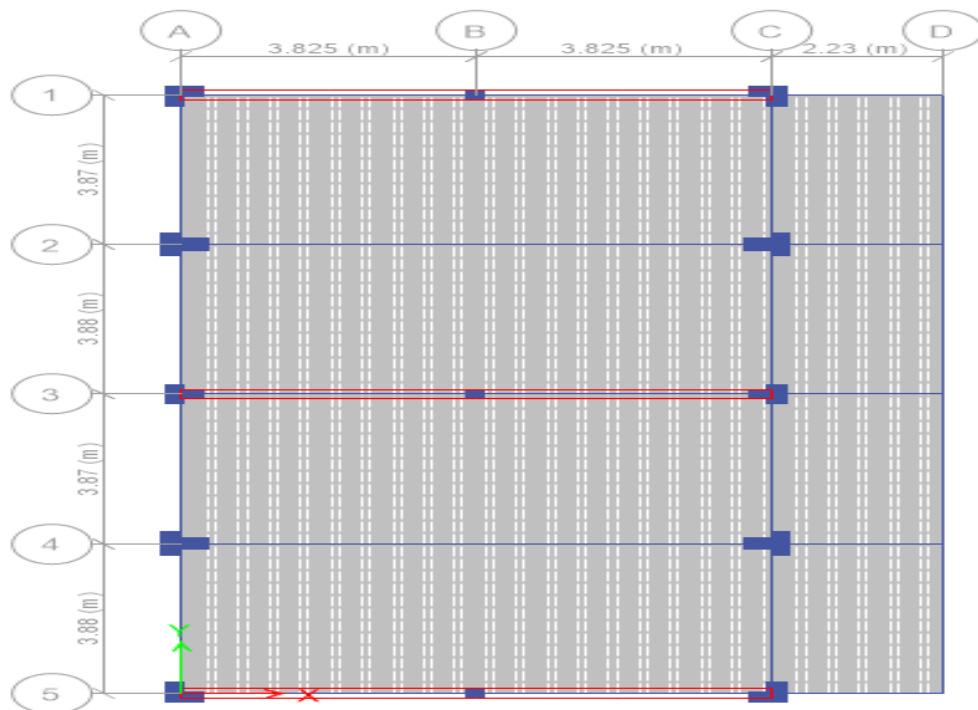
Modelado de las columnas “T” y “L”- vista en planta
